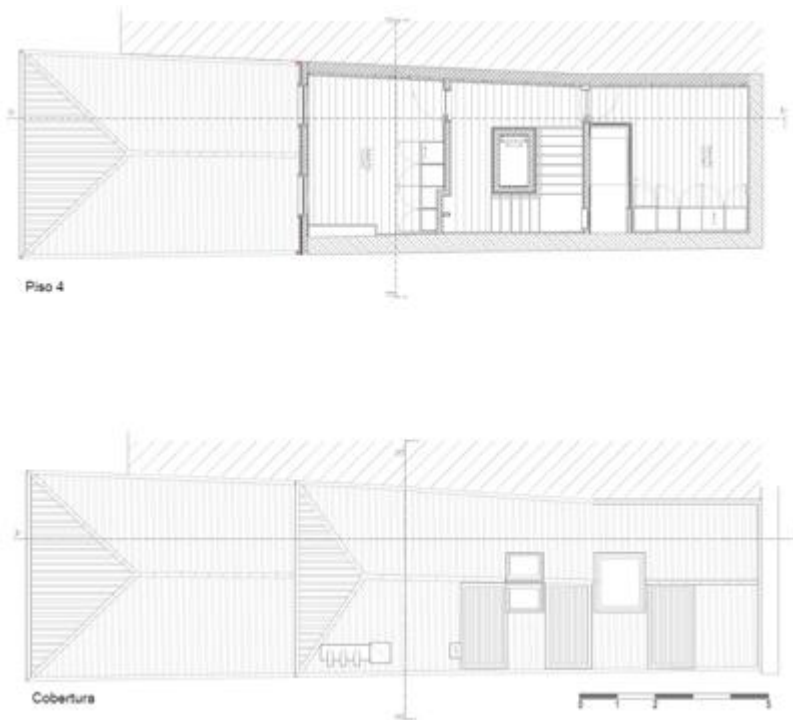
Plantas do Piso 4 e Cobertura [20]
